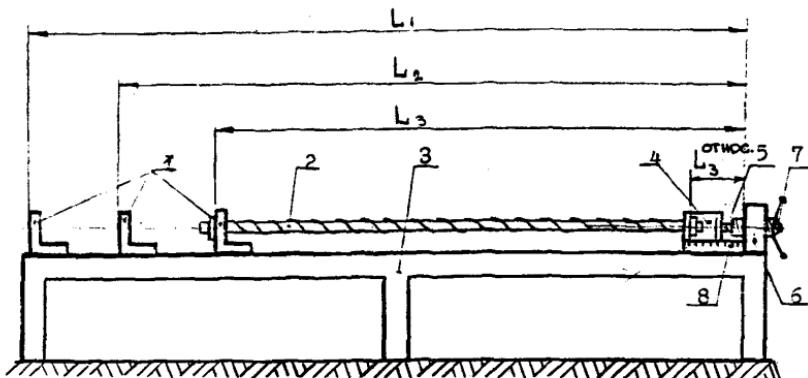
Измерительное устройство ИУ-2 для контроля длин арматурных заготовок
